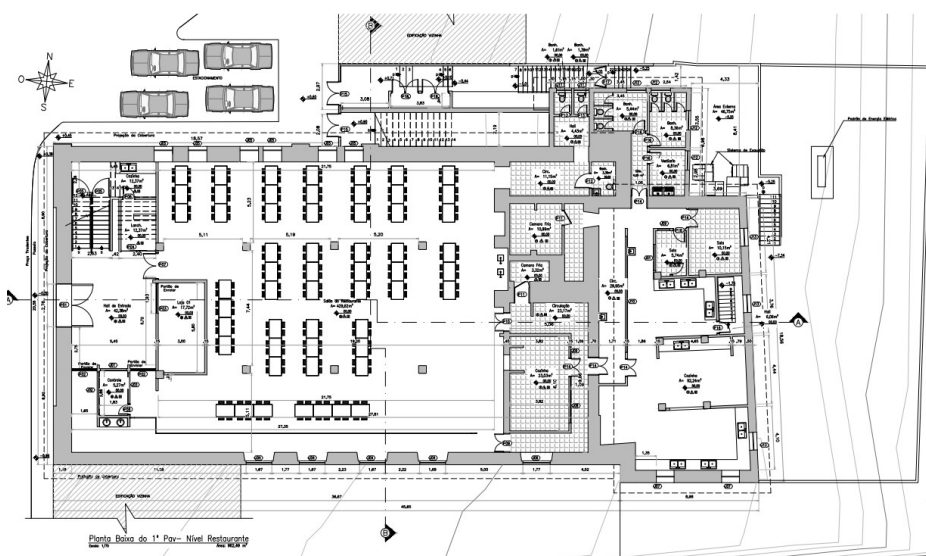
Planta Baixa do 1º Pavimento do Caem
